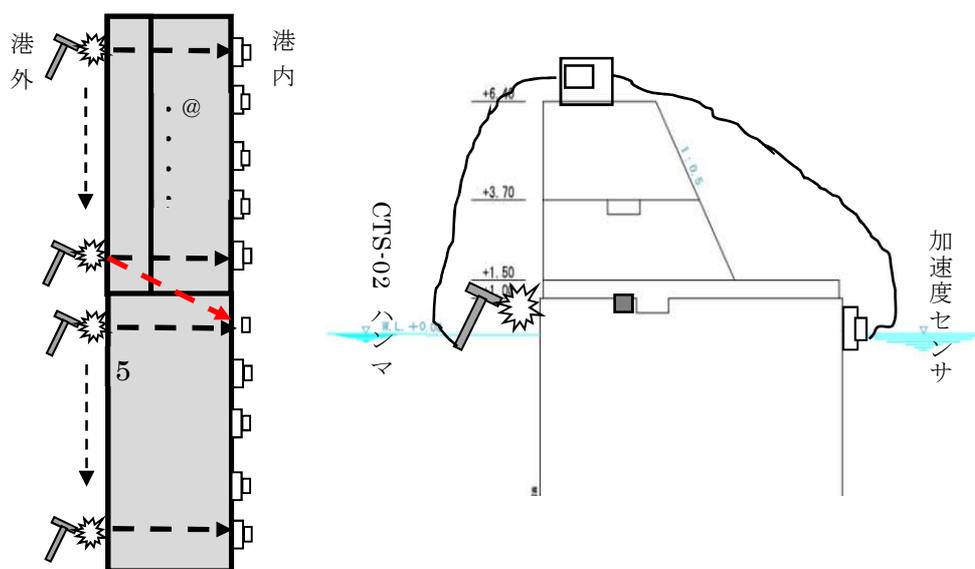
透過法測定イメージ (堤体本体) (左: 平面図、右: 断面図)
